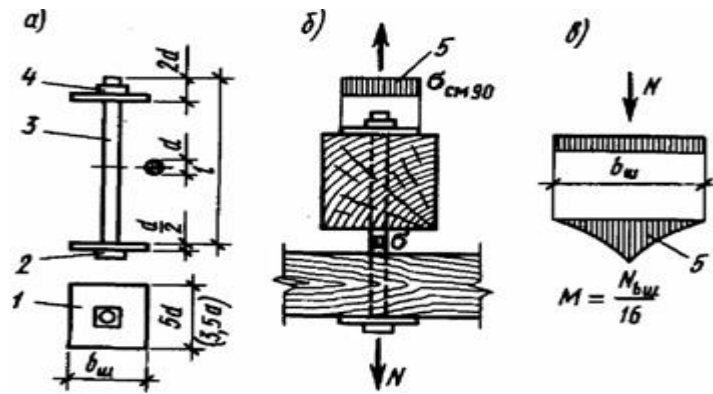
З'єднання на розтягнутих болтах: а — болт; б — схема роботи болта і деревини; г — схема роботи шайби; 1 — шайба; 2 — головка; 3 — стержень; 4 — гайка; 5 — епюри напруг
